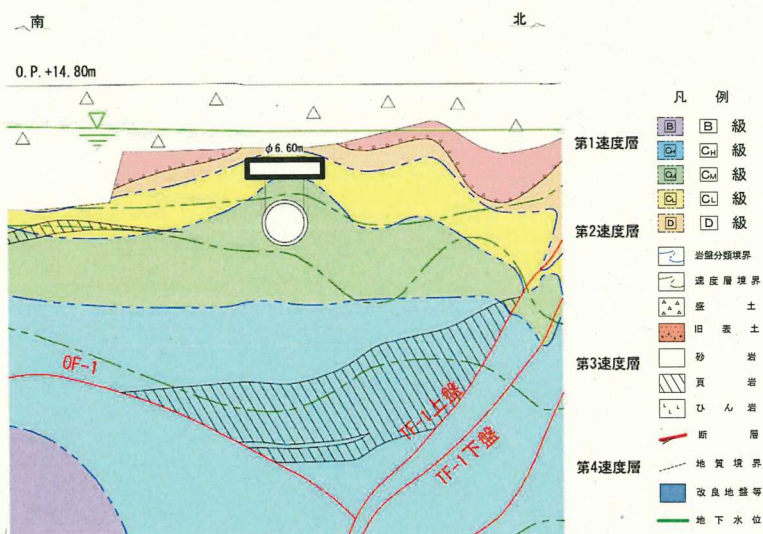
排気筒連絡ダクト (岩盤部) 地質断面図 (断面⑤)
